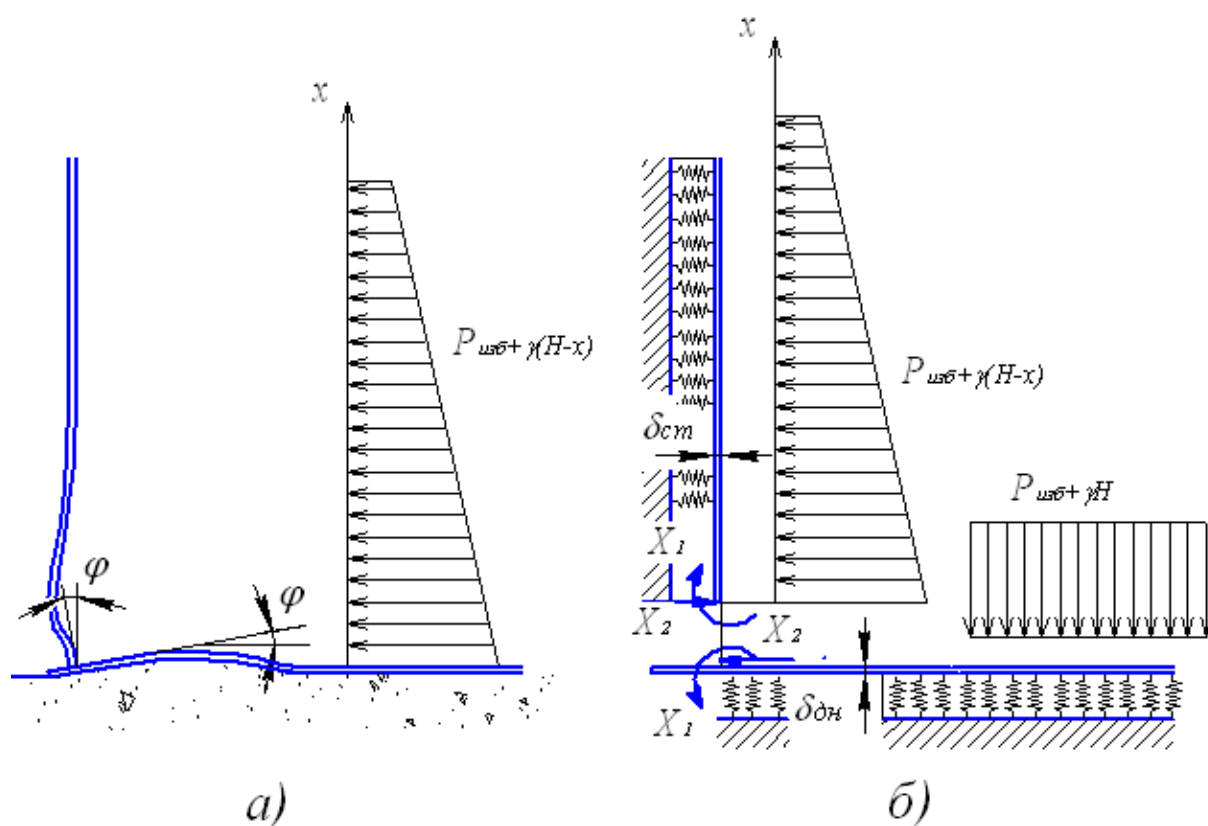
Расчетная схема узла сопряжения стенки резервуара и дна для метода сил: а – исходная система – совместная деформация стенки и дна; б – основная система для расчета нижнего узла методом сил
